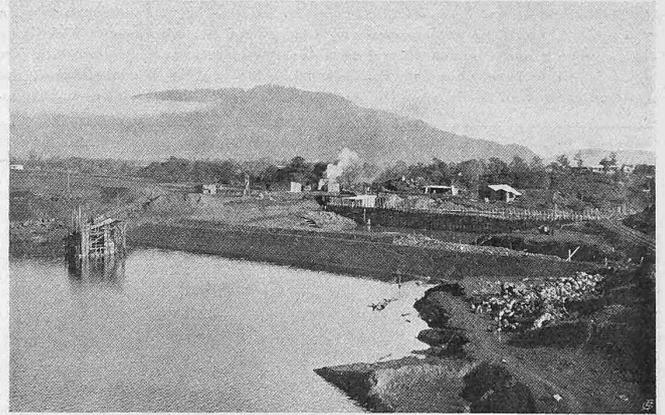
Wasserseitiger Dammfuss, dahinter eingeschaltete Kernmauer.
